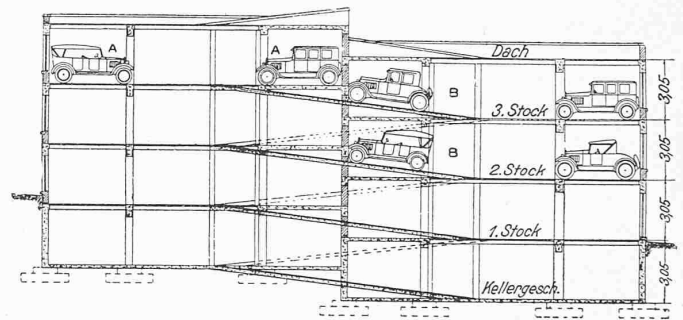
Schnitt durch eine vierstöckige Grossgarage mit d'Humi-Rampen. Masstab 1: 350.
